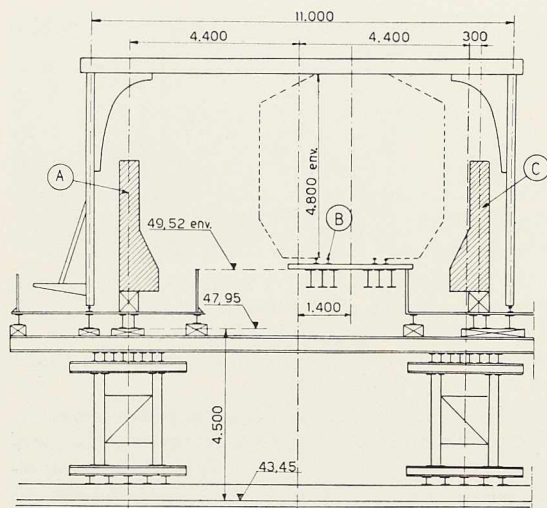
Exhaussement de l'ouvrage provisoire. Coupe sur le plancher de travail :
